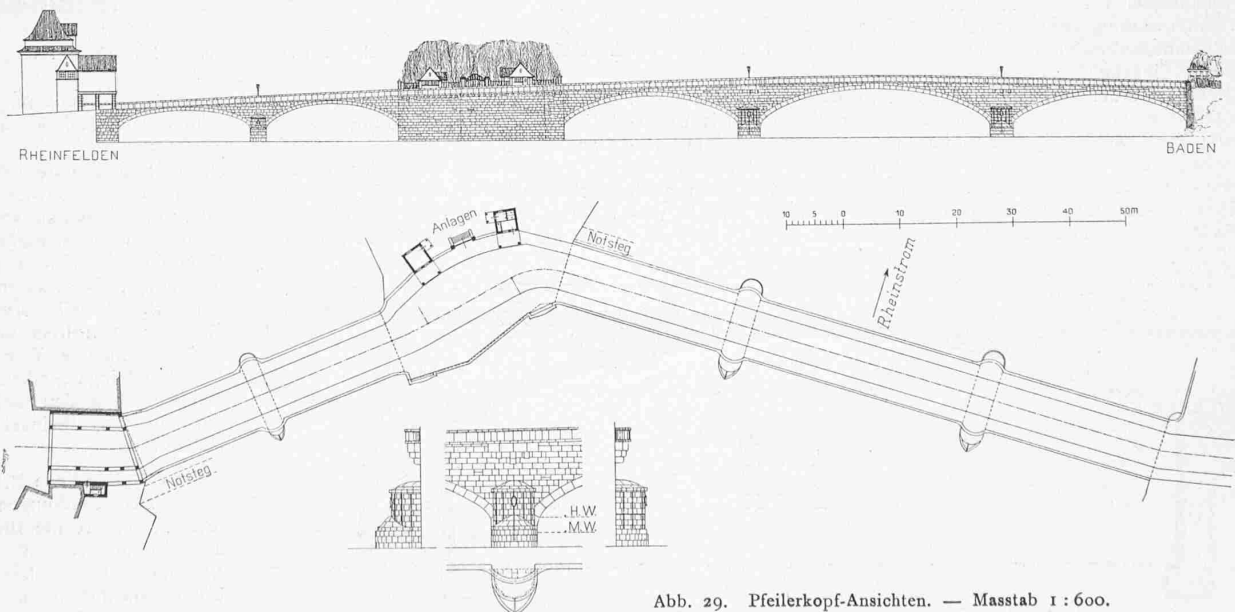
Pfeilerkopf-Ansichten. — Masstab 1 : 600.
